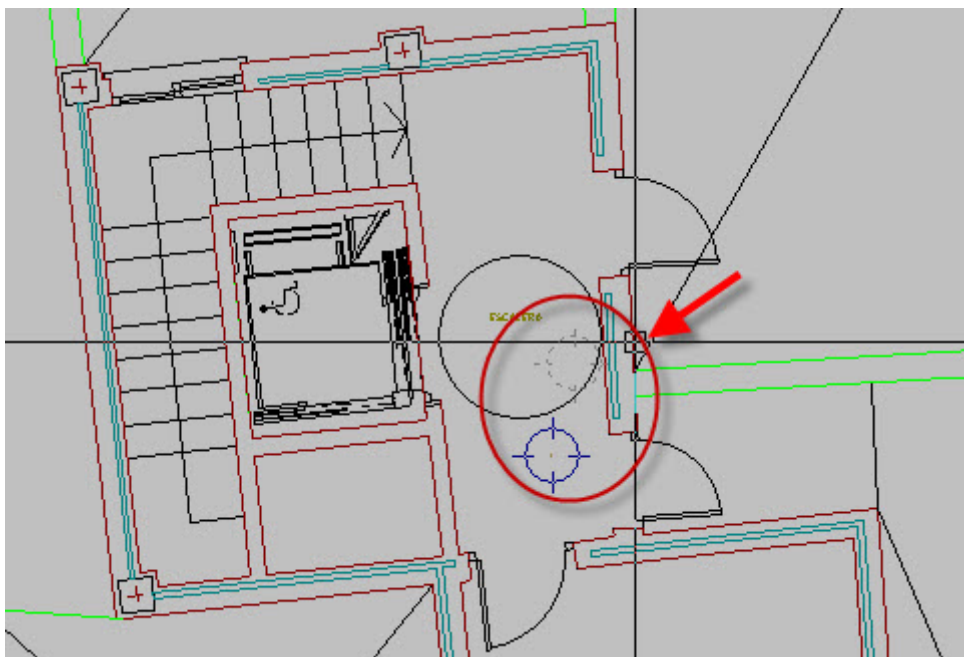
DETALLE Instalación ICT planta semisótano (dimensionada)
